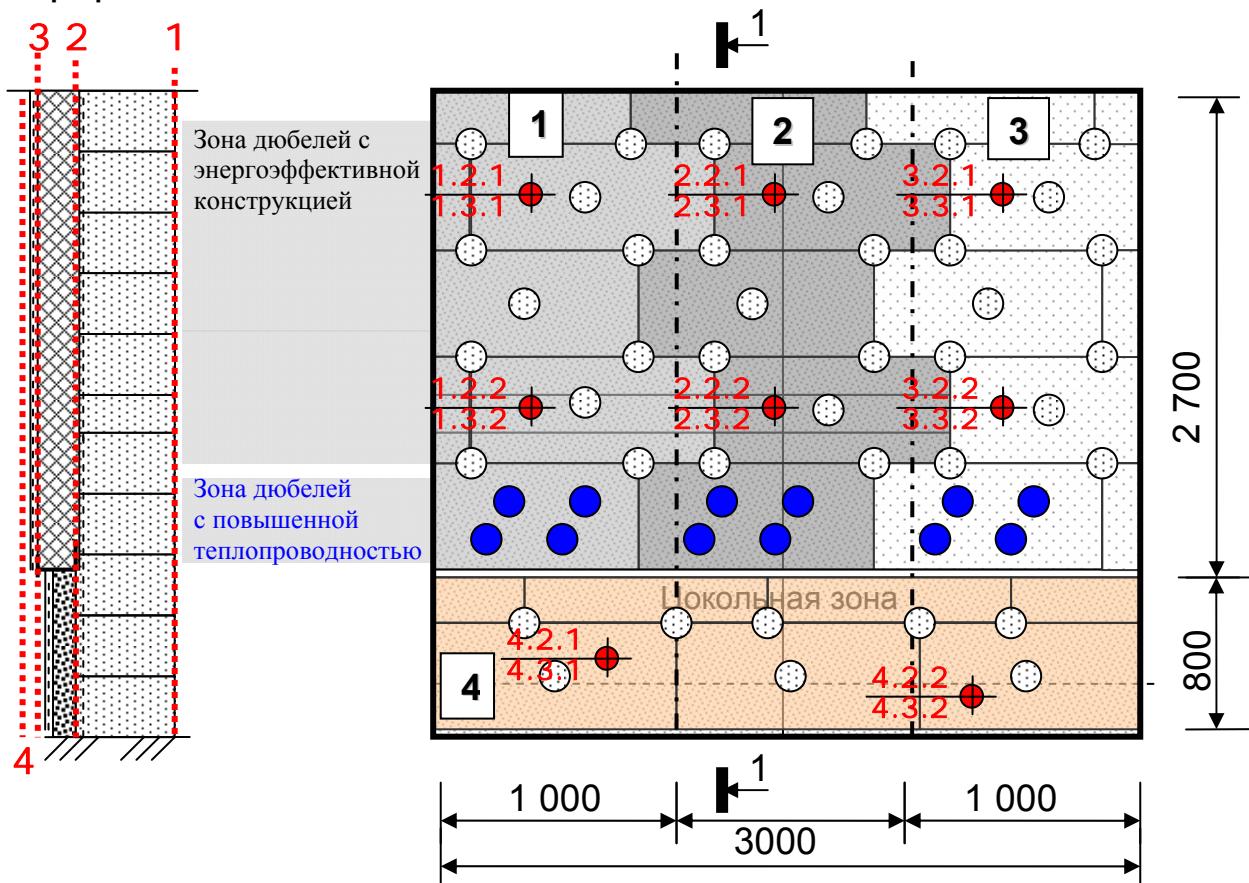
Схема фрагмента стены из газобетонных блоков с наружной теплоизоляцией и защитно-декоративной отделкой Ceresit
